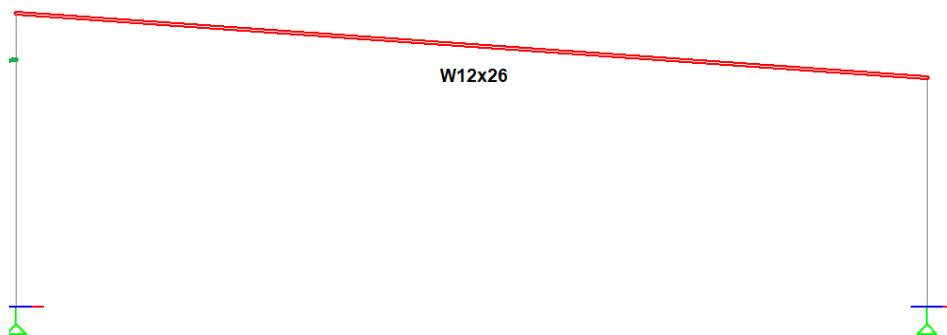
Modelo 2D de estructura resistente - Columnas. Fuente: Elaboración propia.
